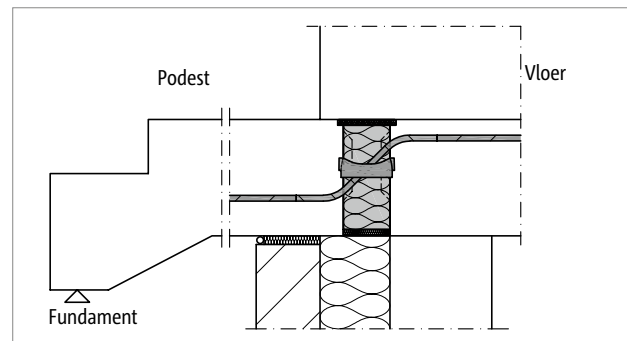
Schöck Isokorb® T type Q-E: Aansluiting bij buitenisolatie
